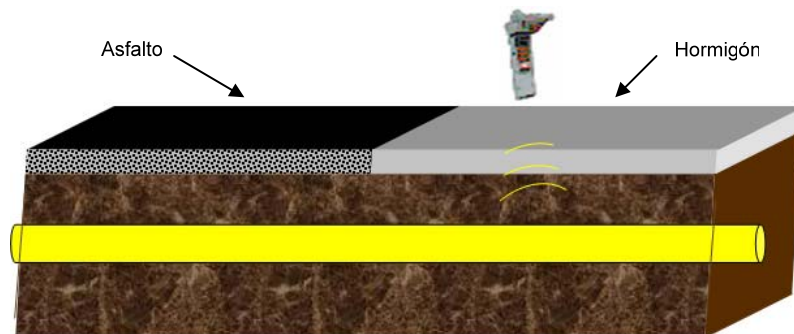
Inspección con PCM en asfalto y hormigón armado.
